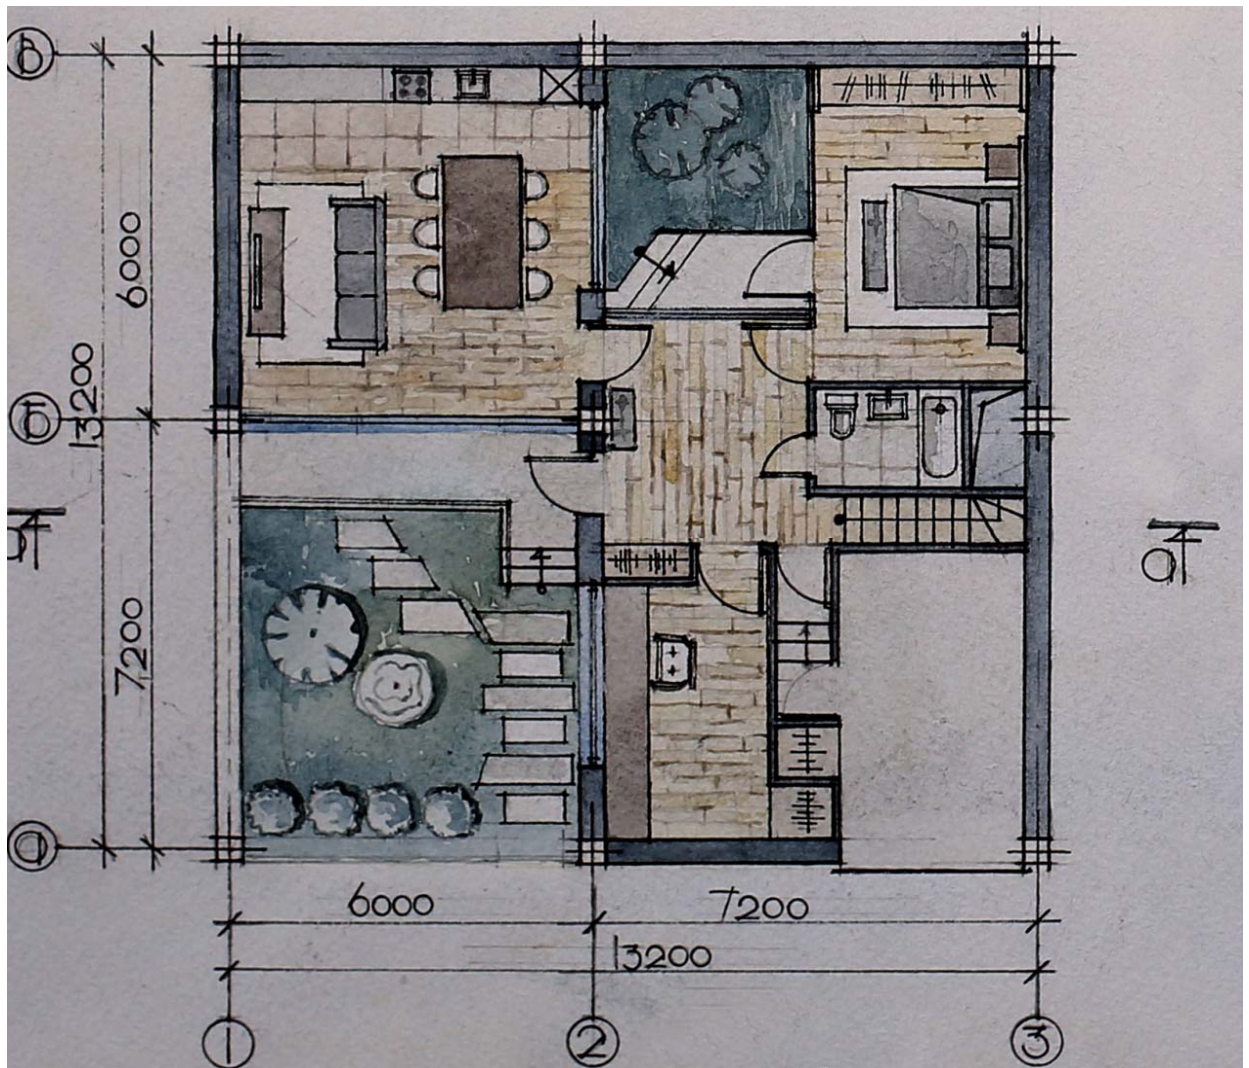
Проект 2-х этажного жилого дома. План 1-го этажа
